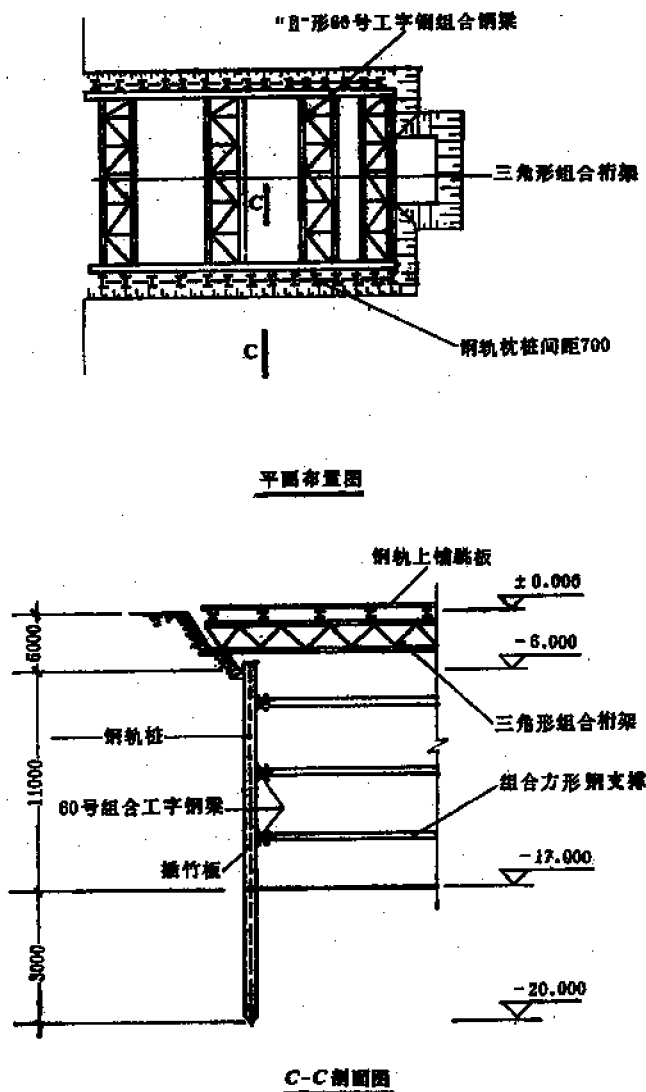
(5) 二级泵房基坑支撑平面布置示意图
